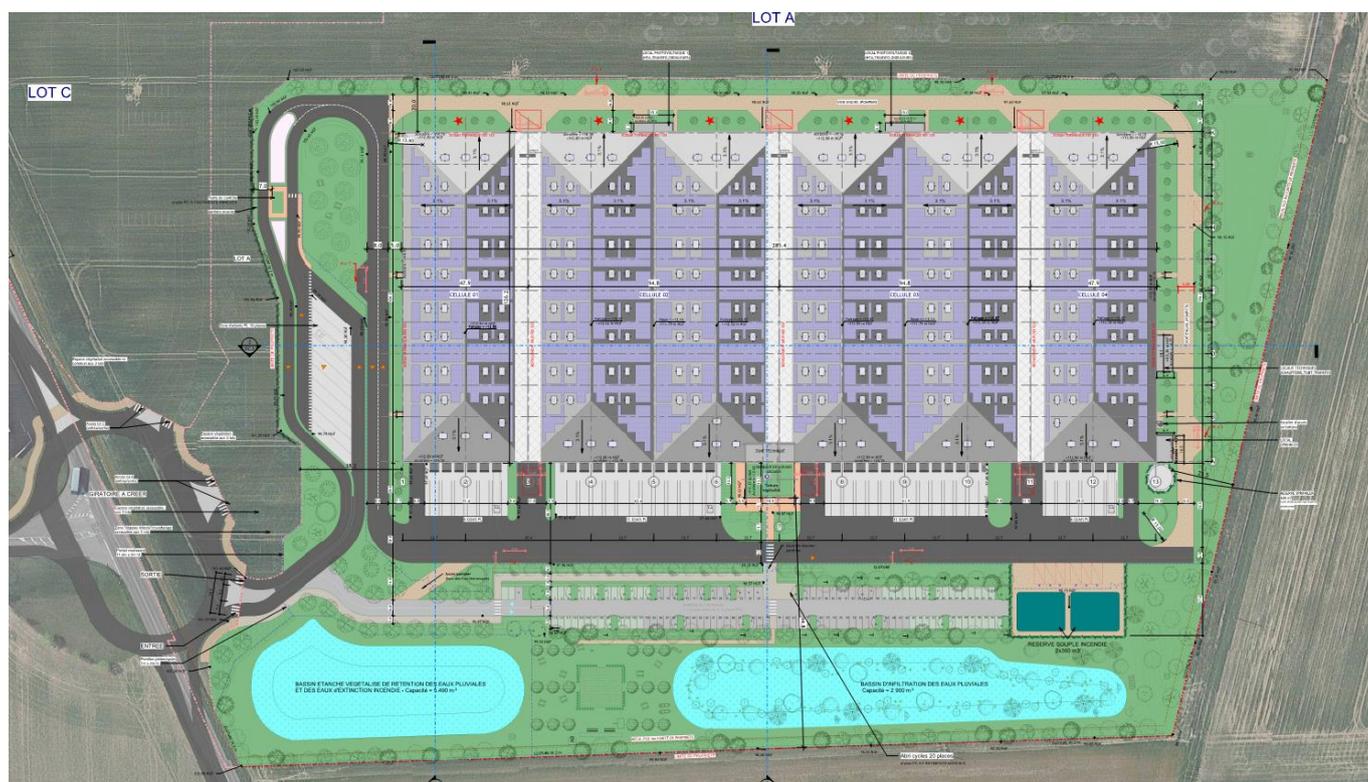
Plan masse du bâtiment de la SNS SENS LOG B
